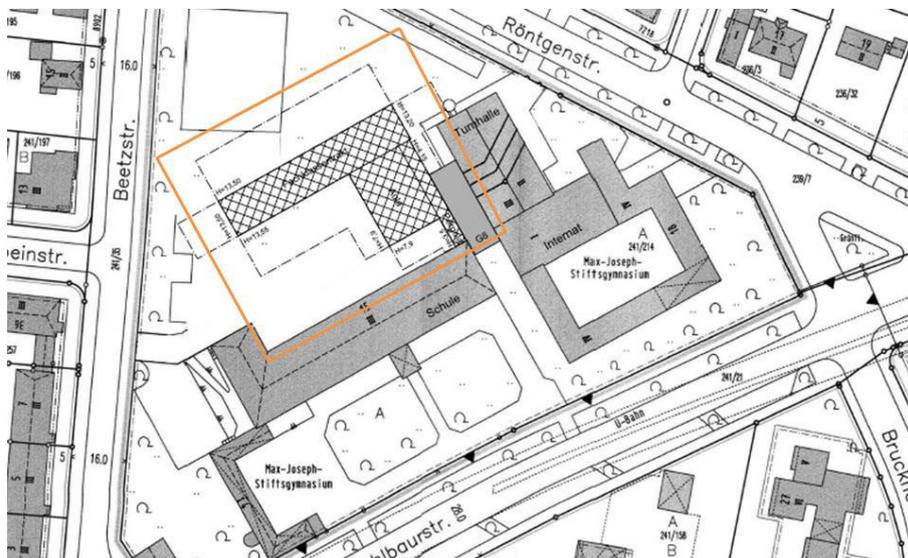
Lageplan (Projekt A)³⁹⁸
